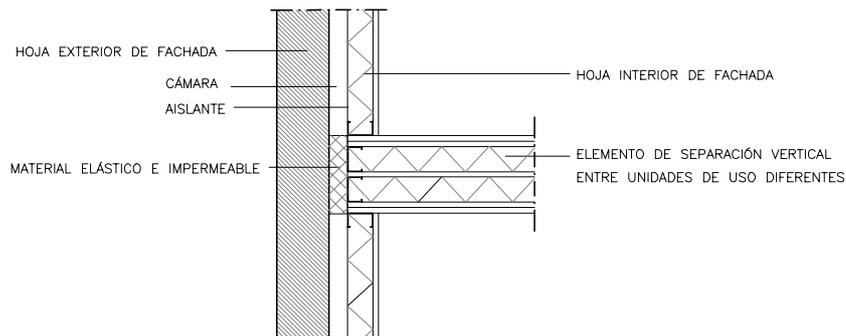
Vista en planta del encuentro de un elemento de separación vertical de entramado autoportante con una fachada.
